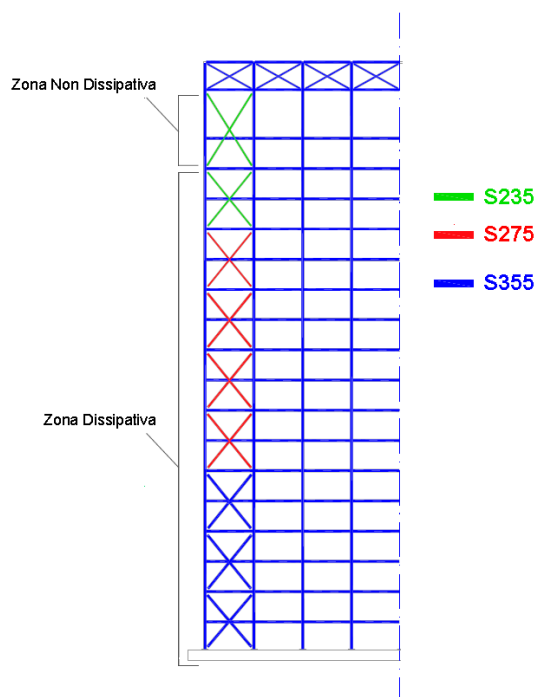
Porzione della sezione Longitudinale della struttura con evidenziate le qualità di acciaio utilizzate per i rispetto delle prescrizioni delle NTC08.
